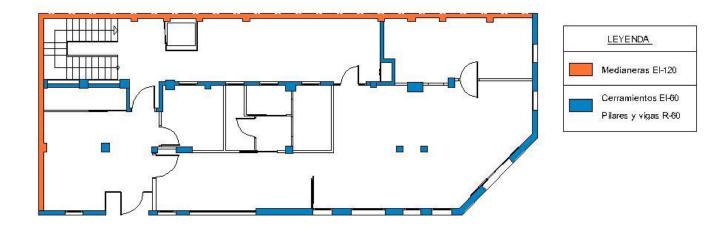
Plano de planta baja con resistencia al fuego estructural y de cerramiento. Elaboración propia
